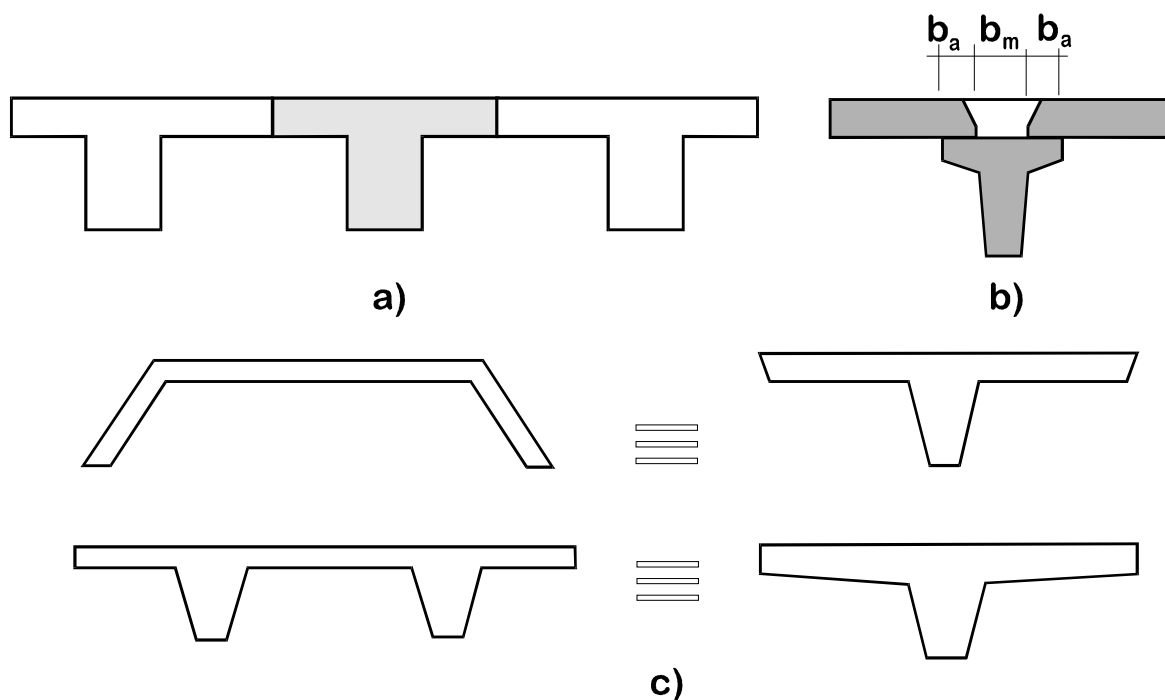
Exemple de secțiuni T a) grindă cu placă monolită b) grindă prefabricată c) element prefabricat de planșeu
